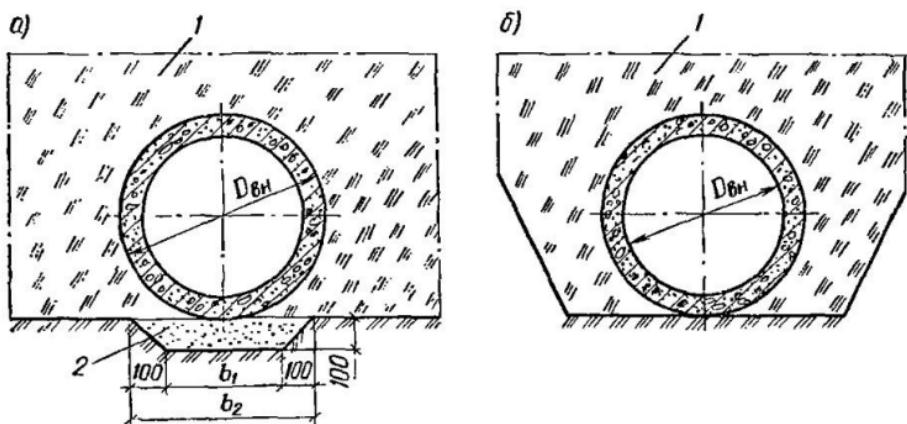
Укладка трубопроводов $D_{BH}=300 \div 500$ мм на естественное основание
